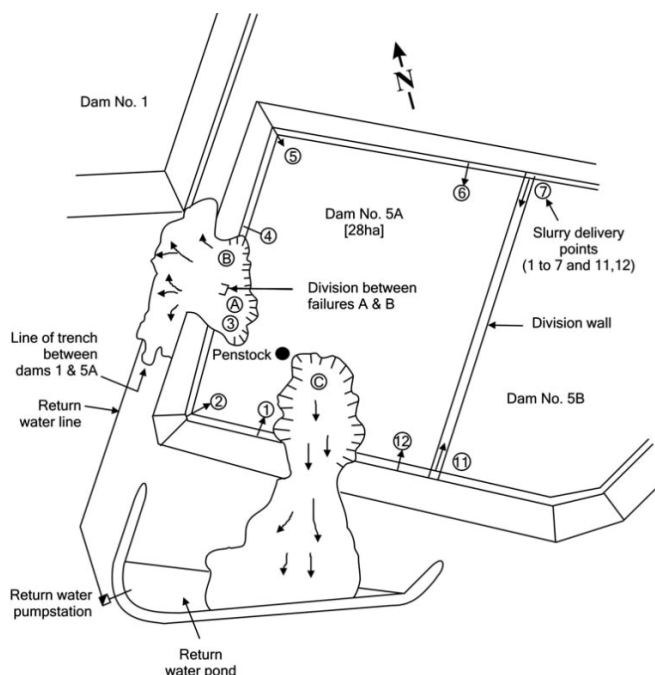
Planta da barragem 5A de Saaiplaas (BLIGHT, 2010).
